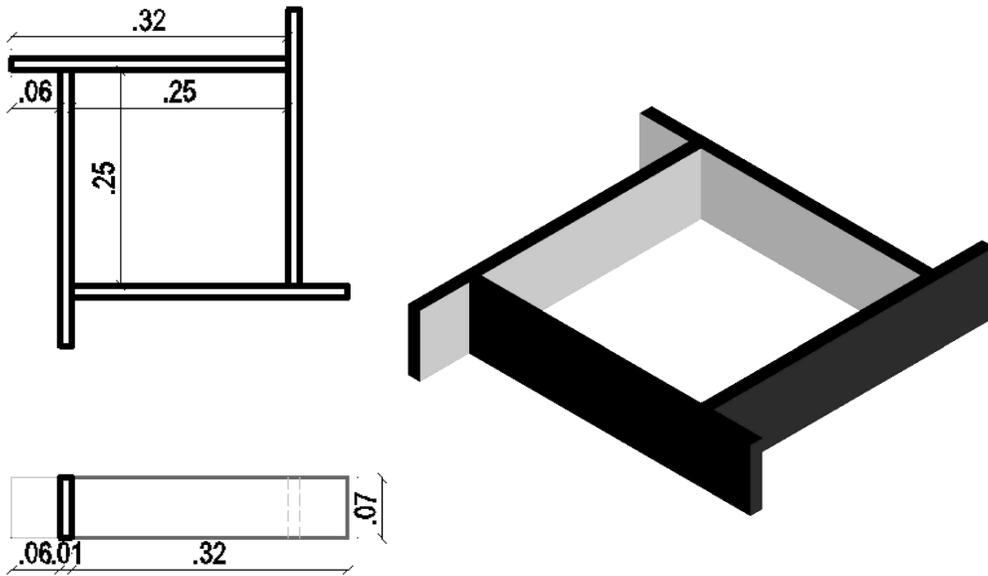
Planos molde para muretes. Elaboración propia, creado en AutoCAD
